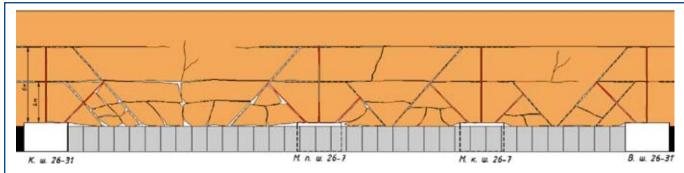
Схема обрушения кровли расслоением и отсечением ее методом НГР из выработок, прилегающих к монтажной камере 26-31
